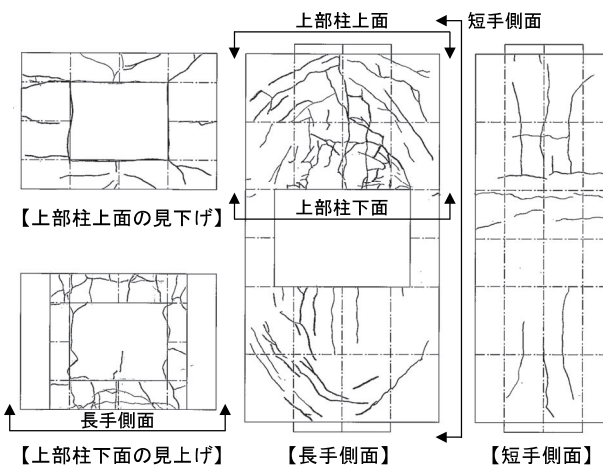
実験終了時のひび割れ状況 (No.5)
